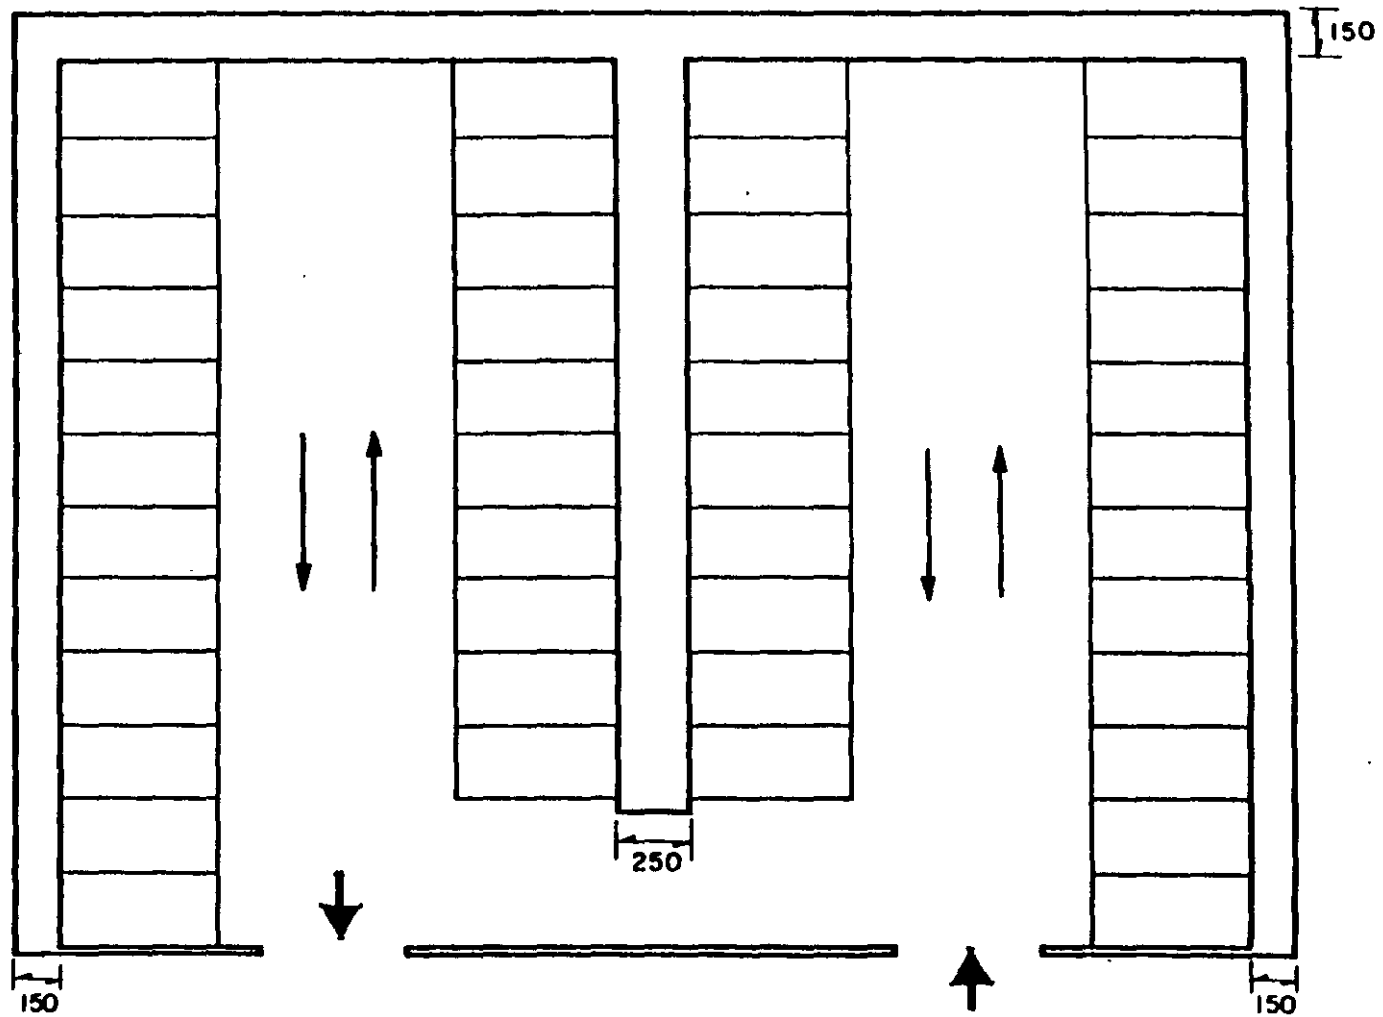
DIMENSIONES DE LAS BANQUETAS PARA PEATONES
